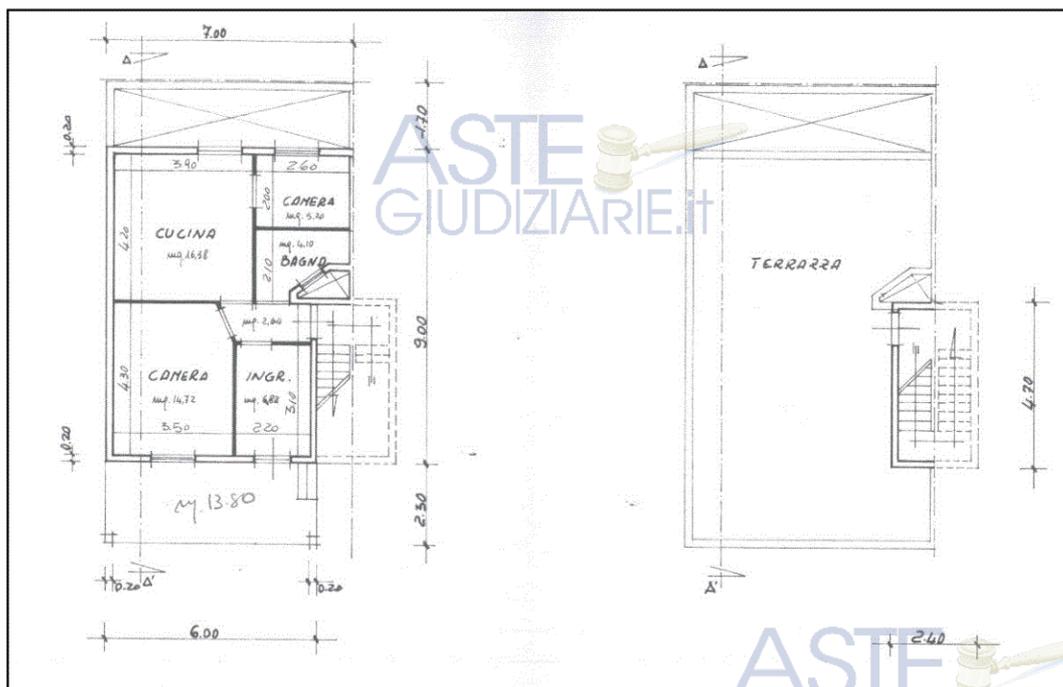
planimetrie progettuali approvate (P.T. a sx, P.1 a dx)
